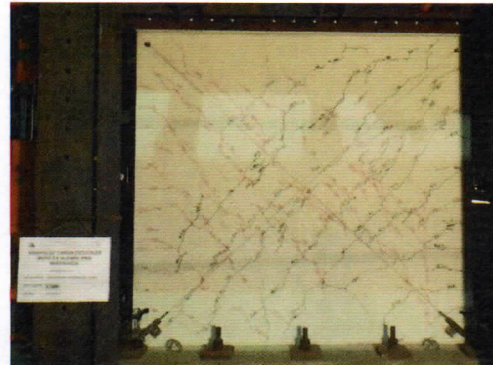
Continuación de grietas diagonales hacia la esquina superior del muro y paralelo a las grietas diagonales para una distorsión 1/300 Vista cara Norte.
